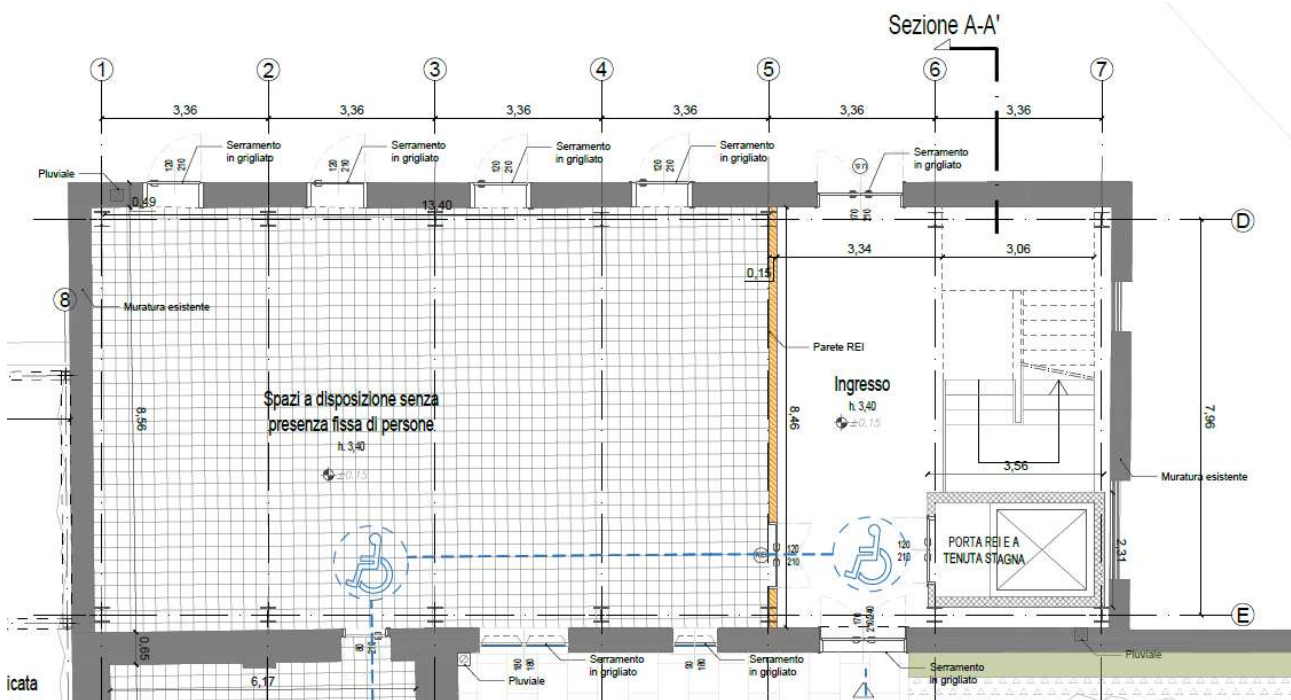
Ex-Galoppatoio - pianta piano terra Edificio 1
